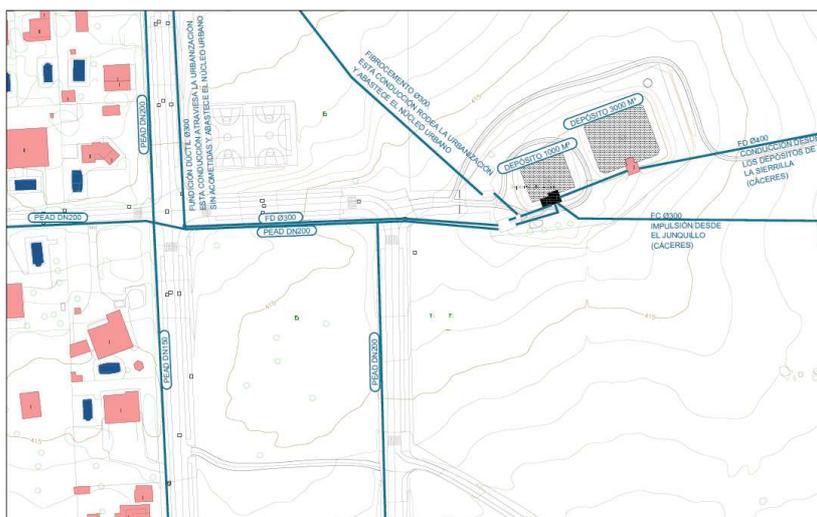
Plano del proyecto de construcción de un depósito elevado en Malpartida de Cáceres.
